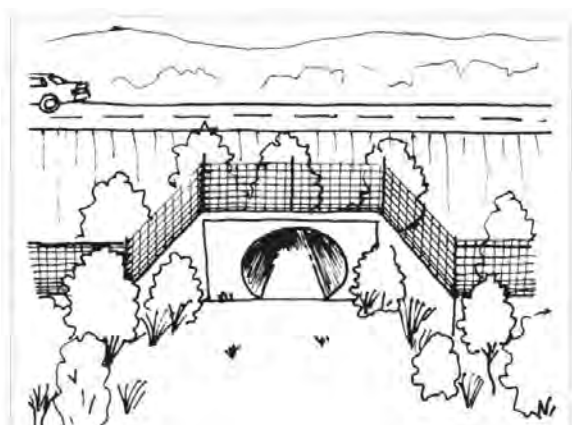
Schema tipo per la disposizione delle piantagioni e della recinzione all'entrata di una passaggio per la fauna. Vista in prospettiva.
